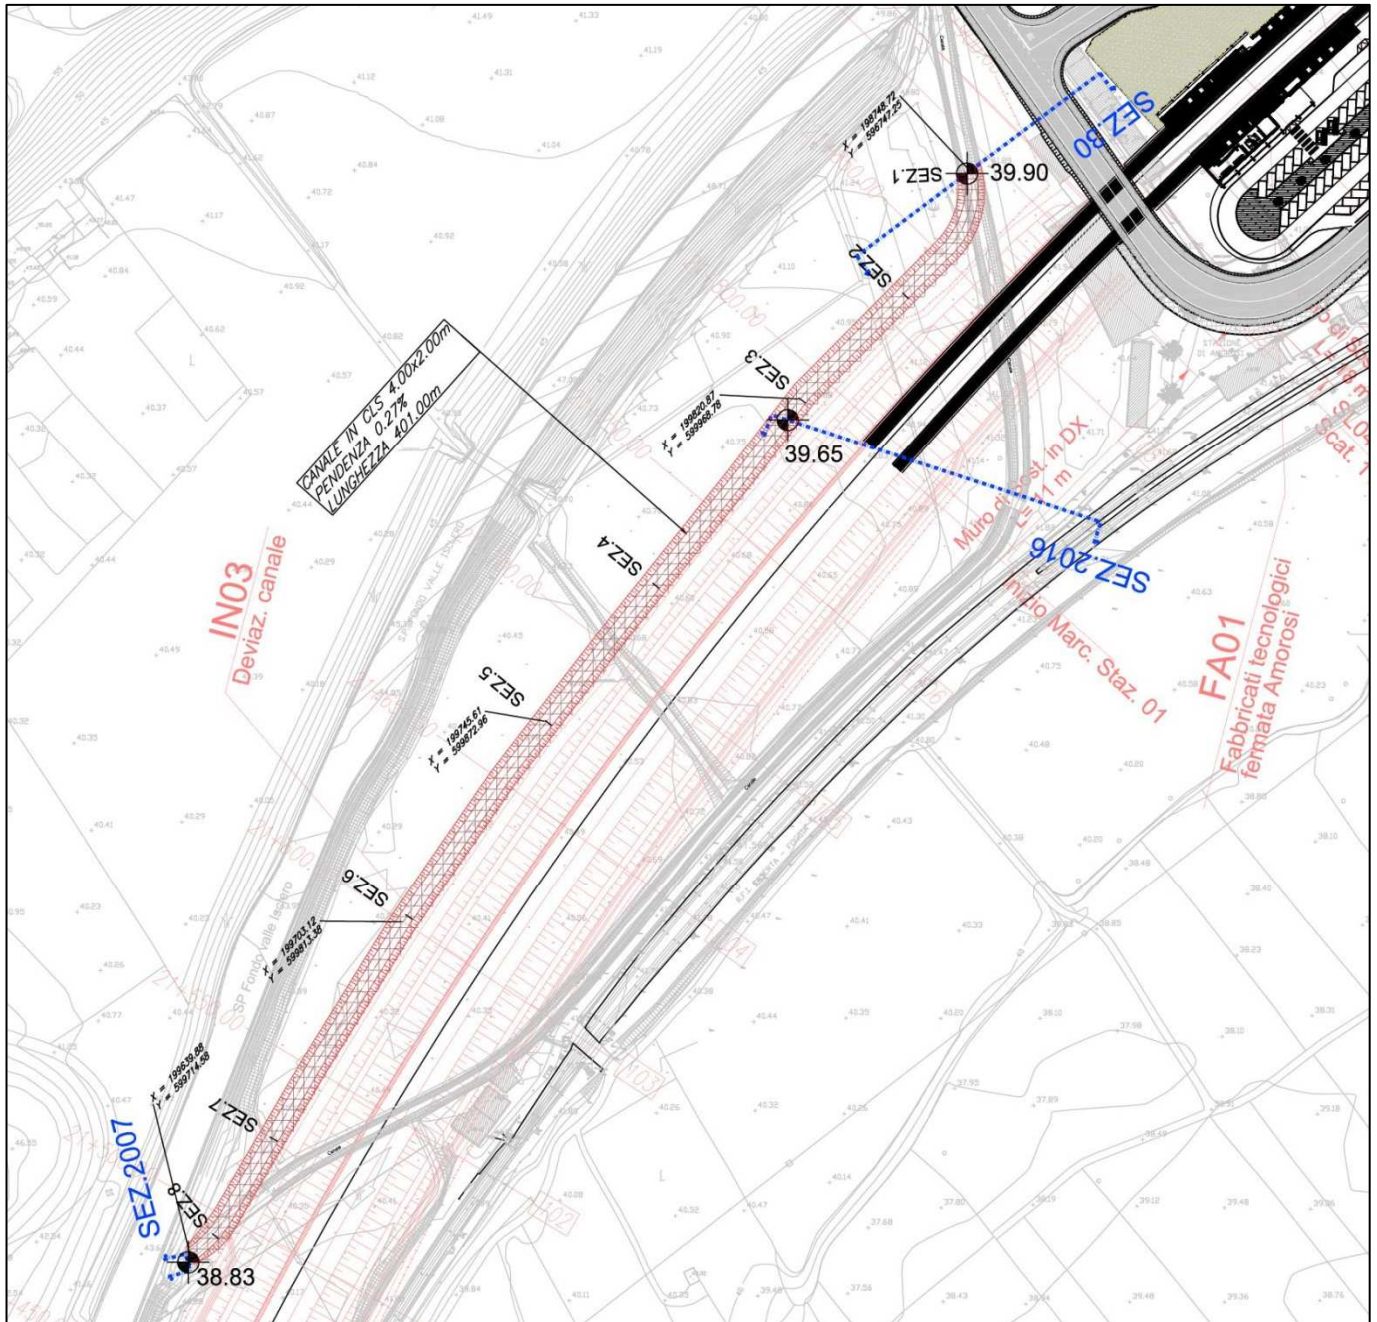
Canale pk.21+540 – Scenario Progetto – Ubicazione sezioni
